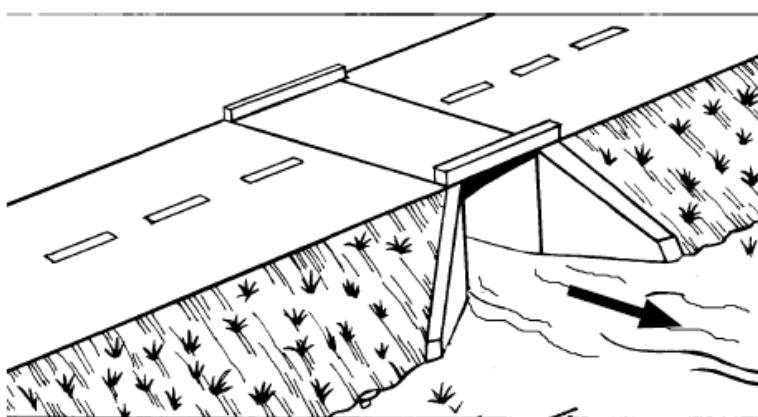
Protección a la entrada y salida de las alcantarillas.
